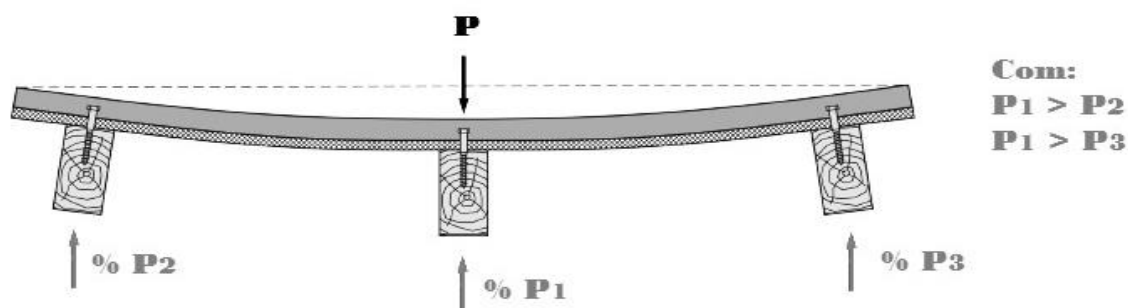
Esquema de um pavimento misto sujeito a uma carga concentrada, (ad. Kieslich, 2014)
